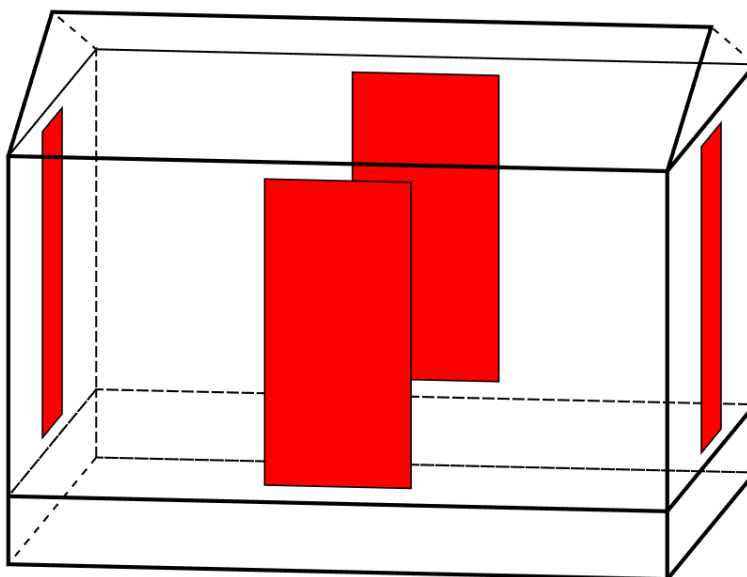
Fensterflächen bei freistehendem Gebäude mit 20 % Fensterflächenanteil
